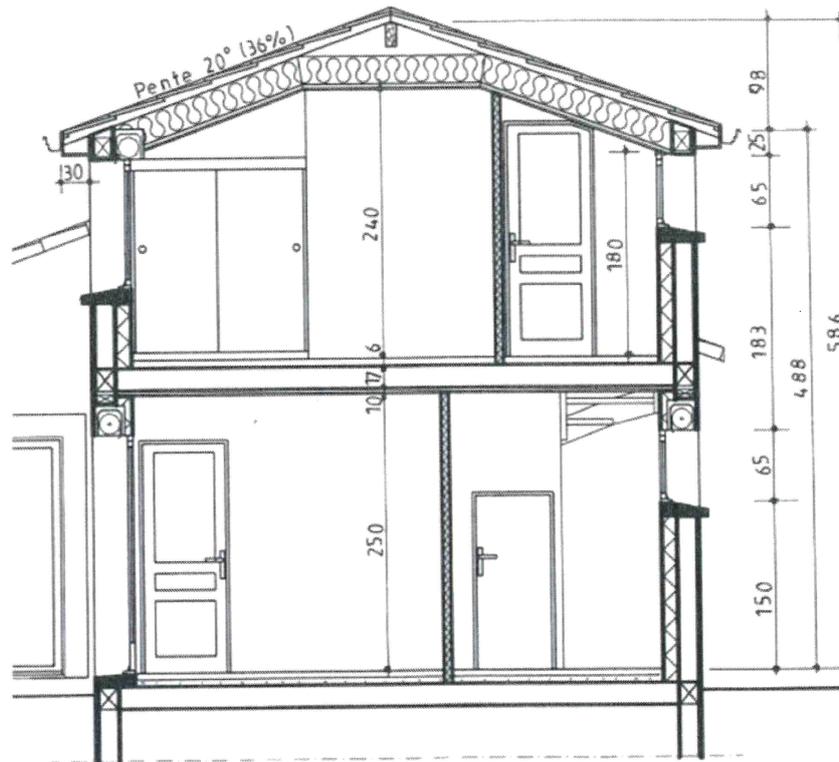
Plan en coupe de l'intérieur de la construction (Echelle : 1/50)
